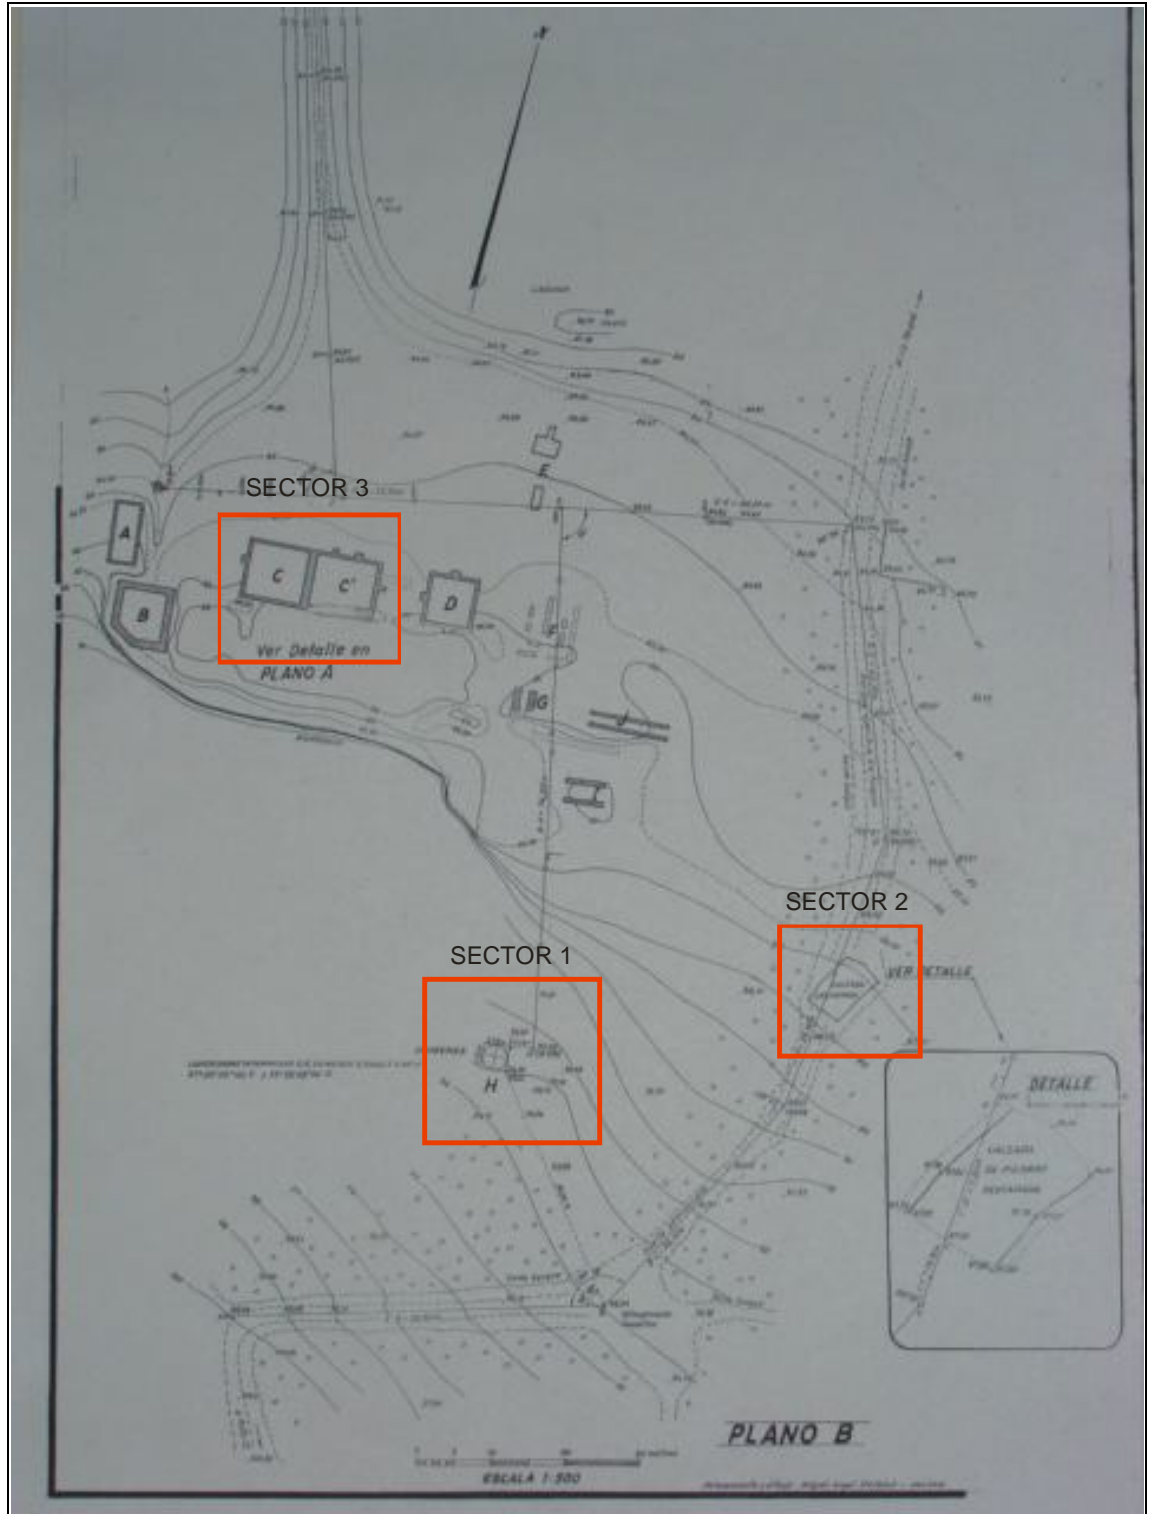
Sectorización de la zona de trabajo sobre Plano B.
